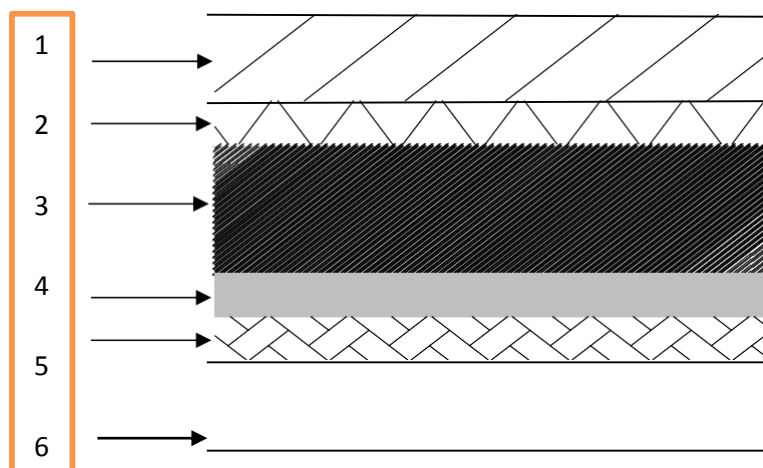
a.2 : Coupe transversal du plancher en corps creux.
